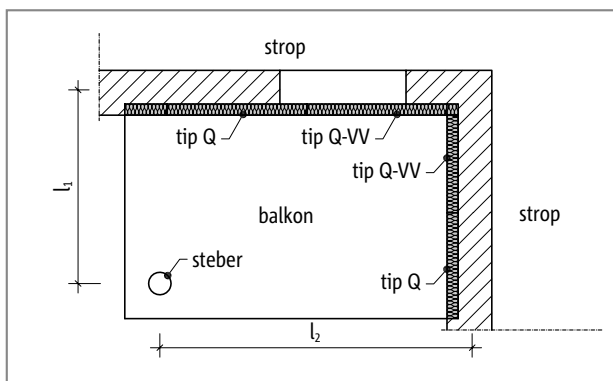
Schöck Isokorb® tip Q: balkon z ležajem na stebrih
